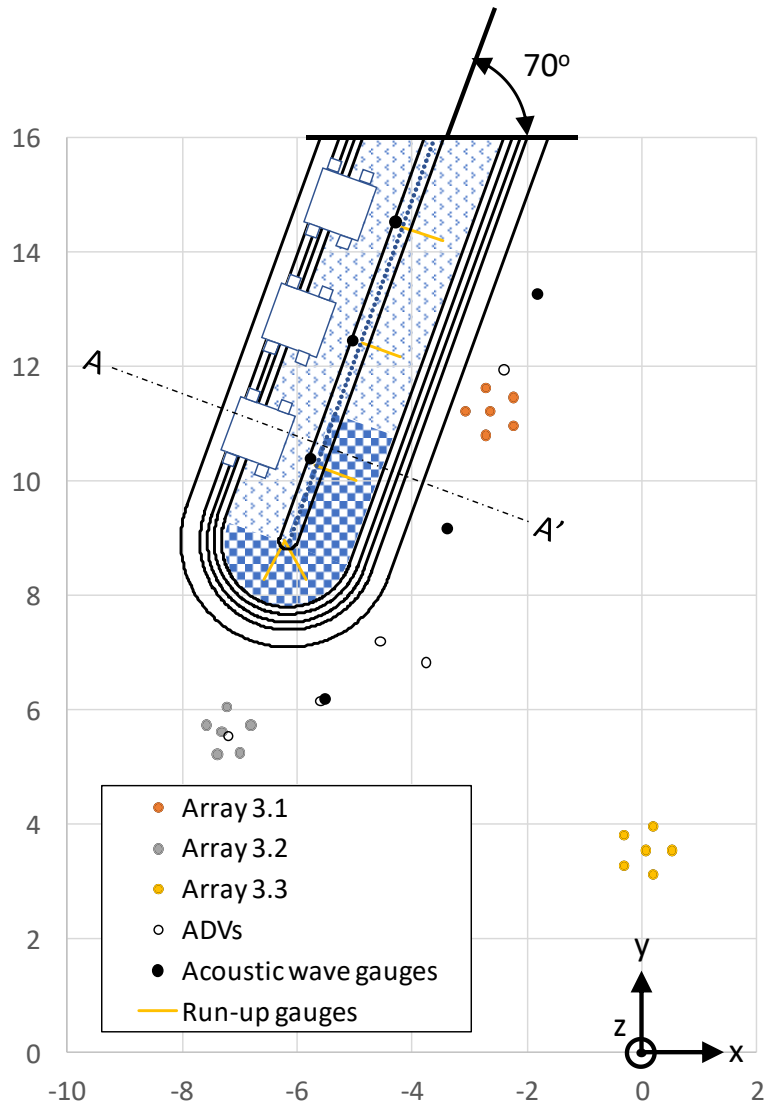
Vista em planta do modelo de quebra-mar (RODBreak, 2017)
